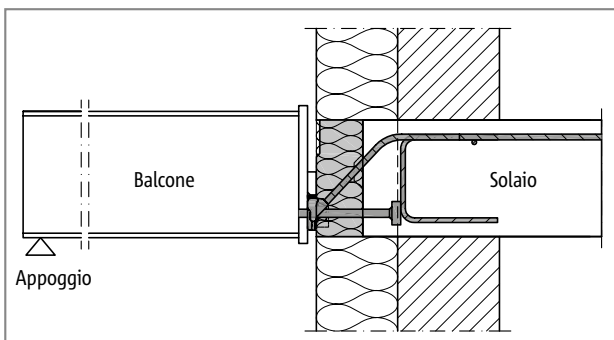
Schöck Isokorb® T tipo SQP: grazie al solaio aggettante, il materiale isolante si presenta esternamente in spessore con l'isolamento della parete; è necessario fare attenzione alle distanze dai bordi laterali
